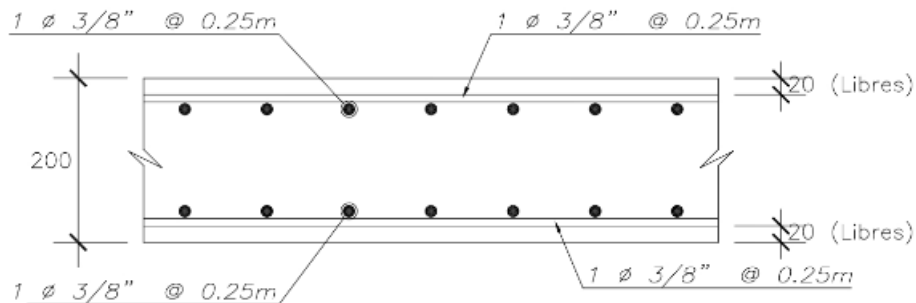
Sección típica de armado de losa maciza con acero mínimo
